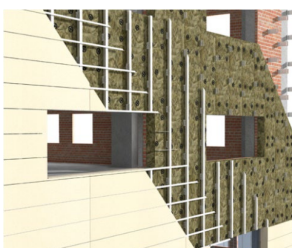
Tipología de fachada tipo I: Fachada Ventilada (FV)
